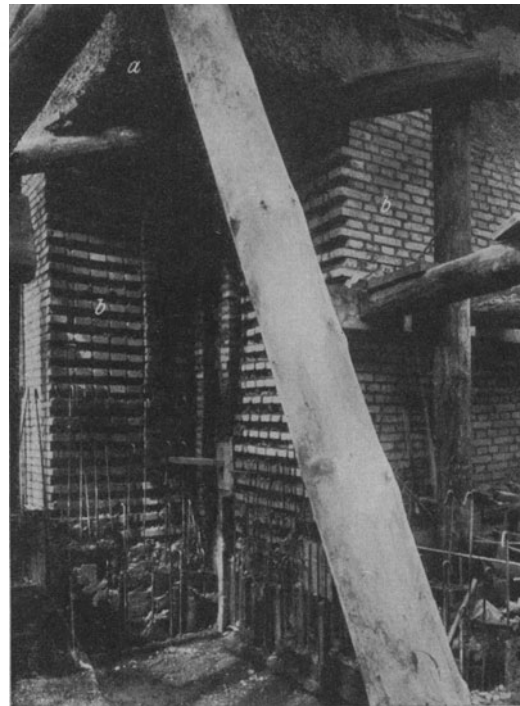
Unterfangung einer Gebäudeecke A (vgl. Abb. 273) bei der Ausschachtung der Baugrube für die Kantonalbank in Zürich. (Siemens-Bau-Union.) a altes Grundwerk, b Unterfangung mit Pfeilern aus Klinkerziegeln auf Betongrundwerk.
